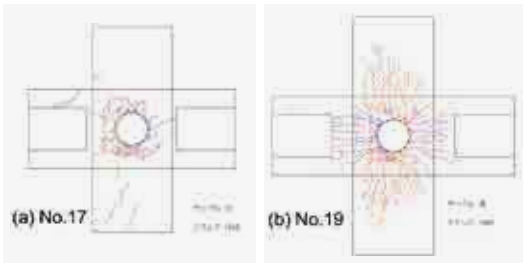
最大耐力のサイクルの回転角ピーク時のひび割れ状況
